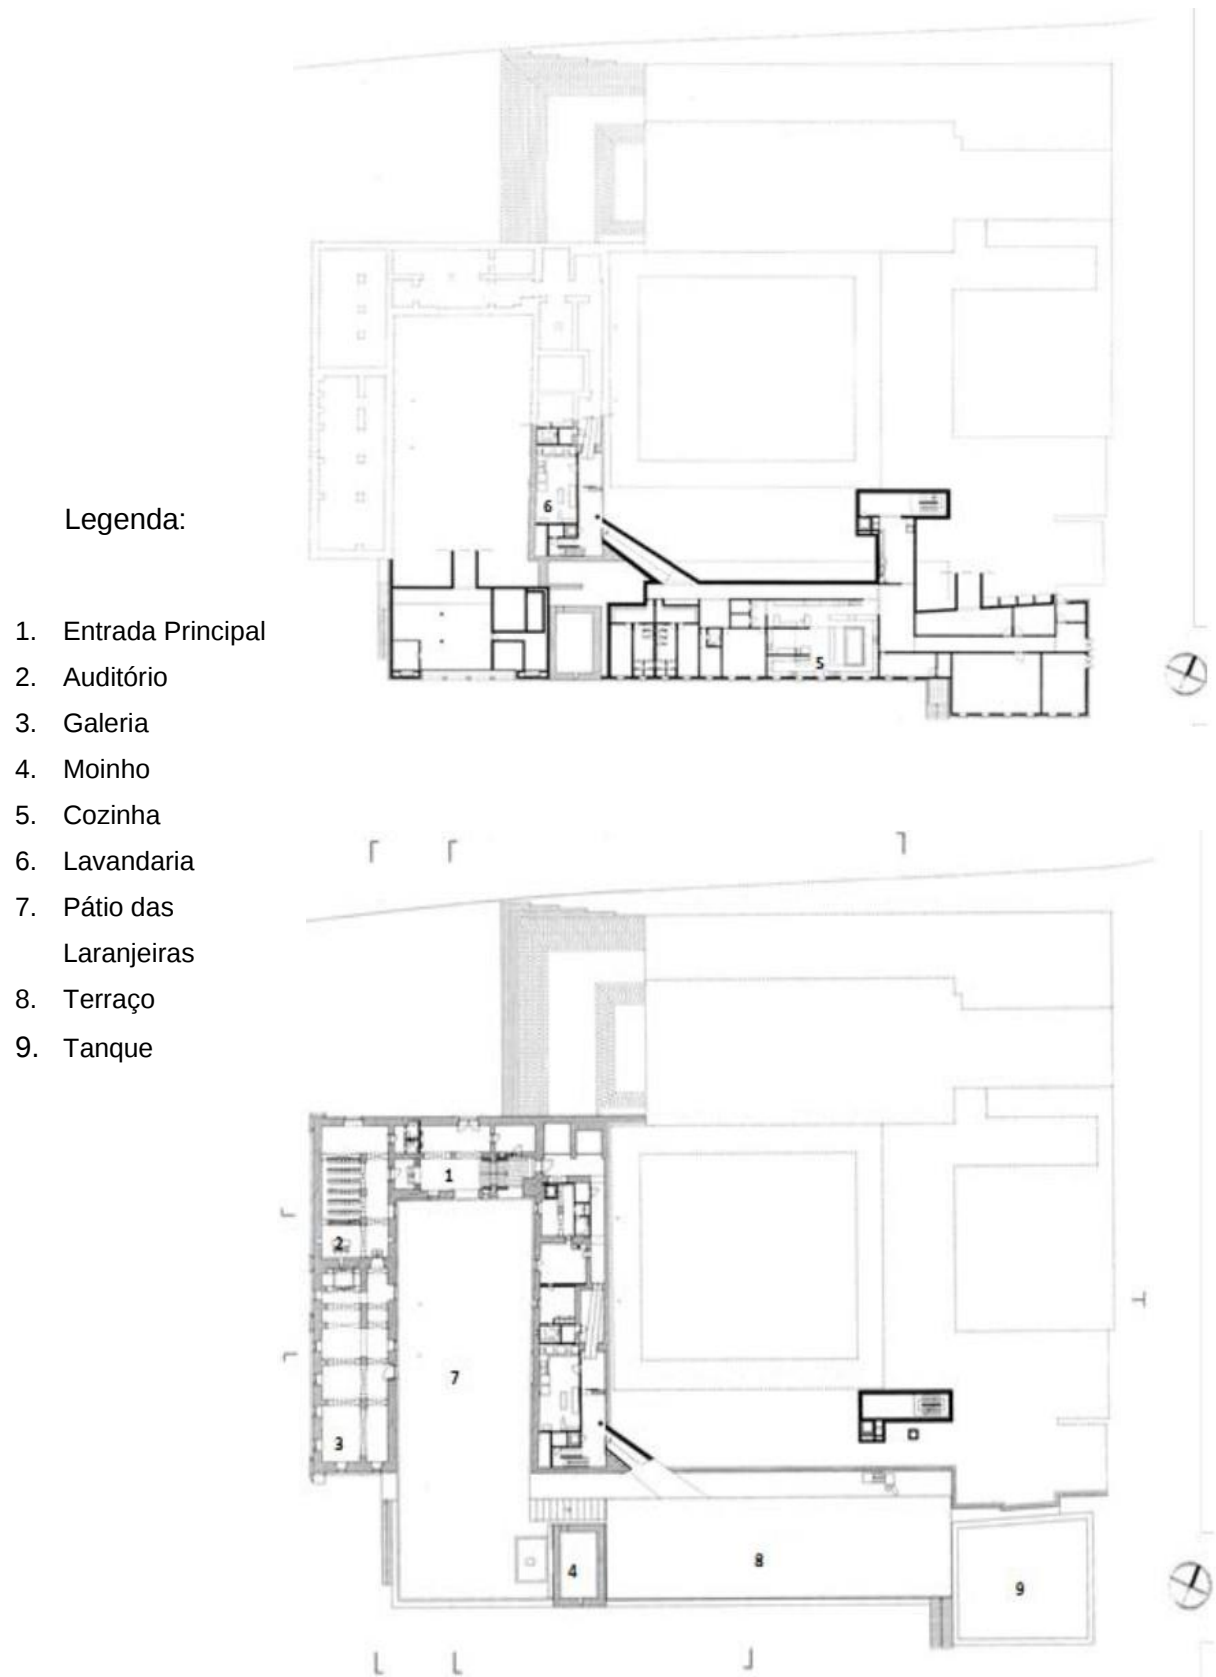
Planta pisos -1 e 0, sem escala.
